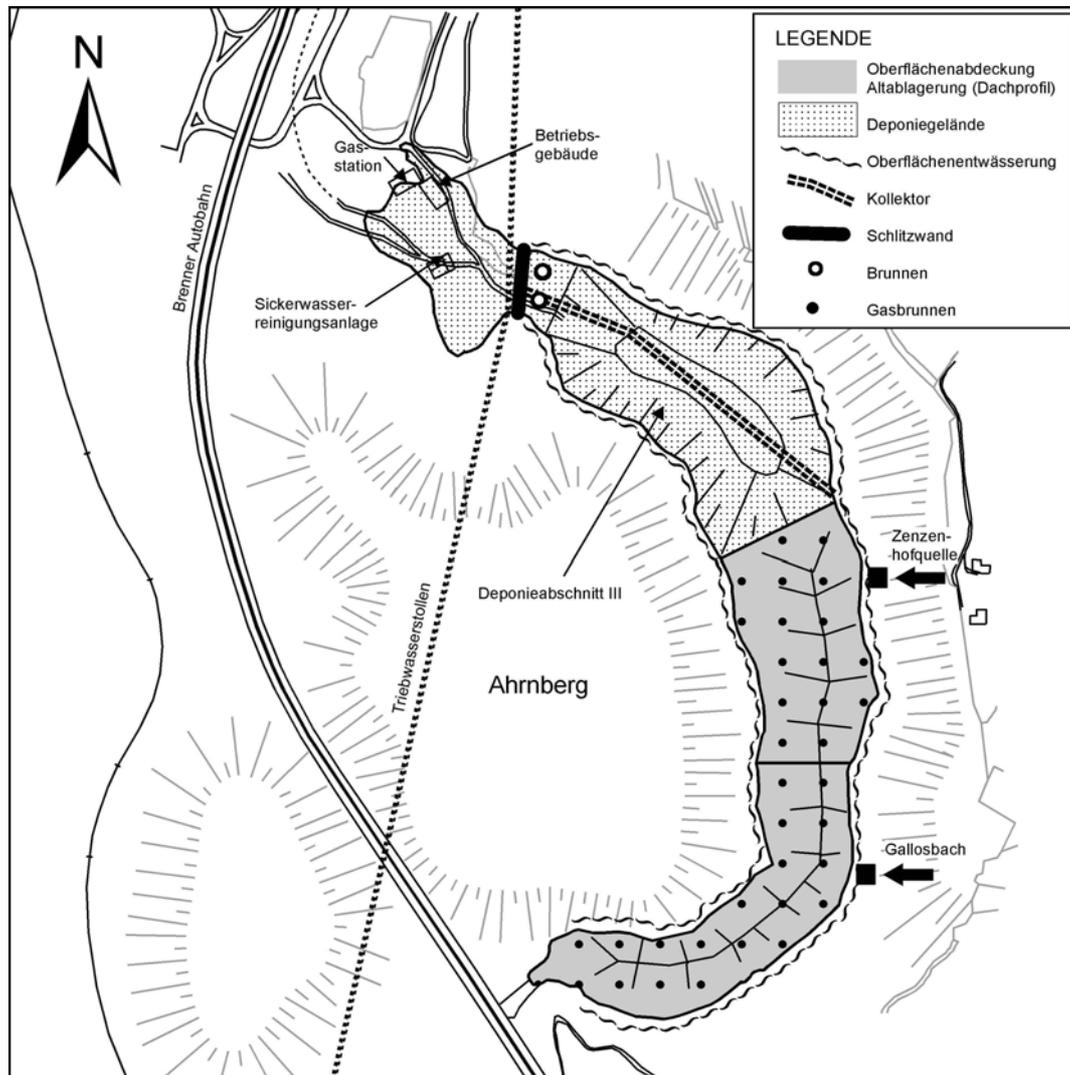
Lageplan Altlast „Ahrental“ – Situation 2004
